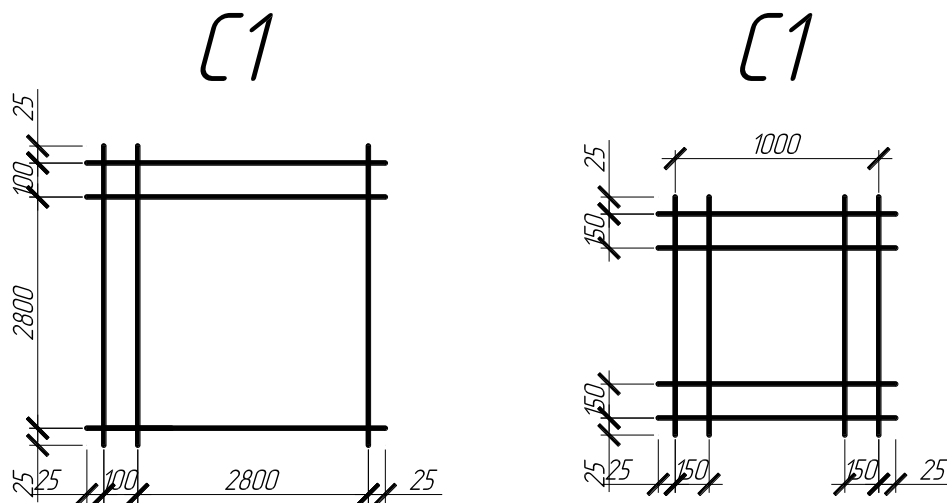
Армирование фундамента в сечении 2-2
